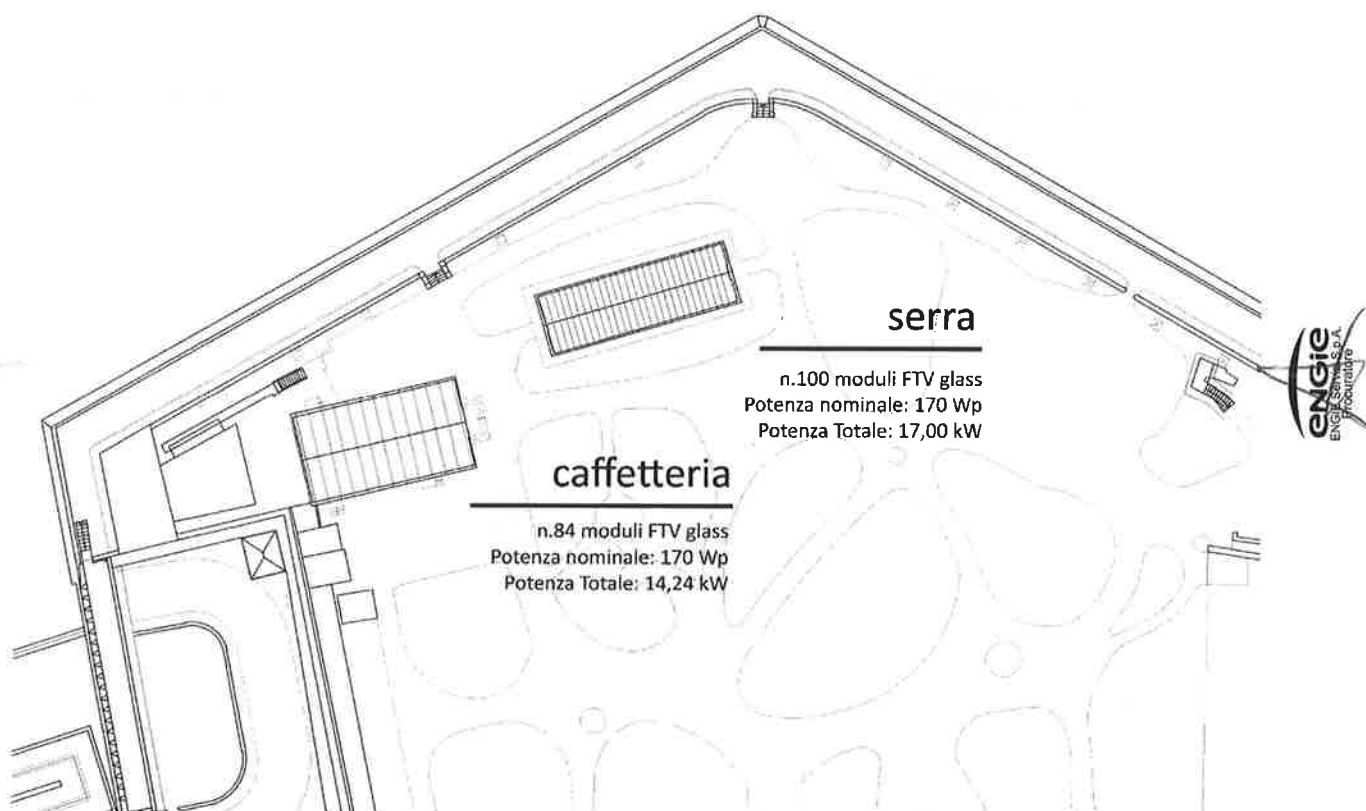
Planimetria con collocazione degli impianti fotovoltaici vetro-vetro
